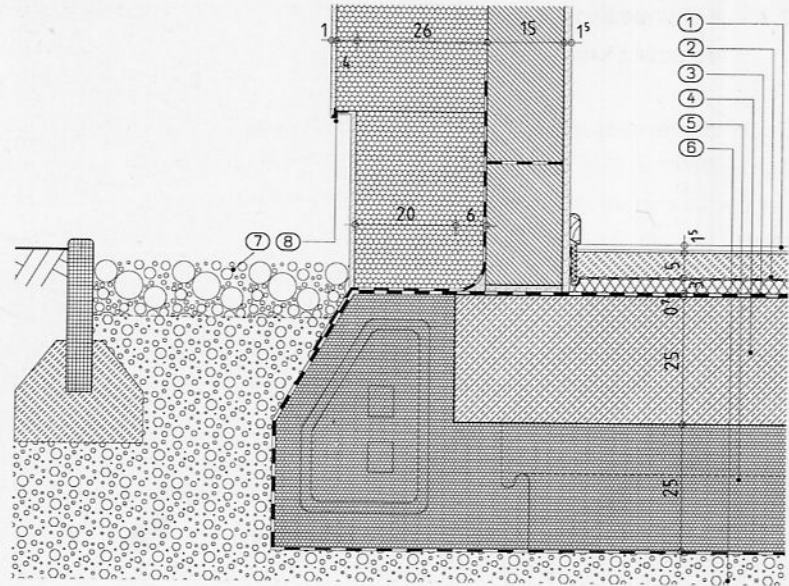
Coupe d'une dalle thermique de l'entreprise Wolf
